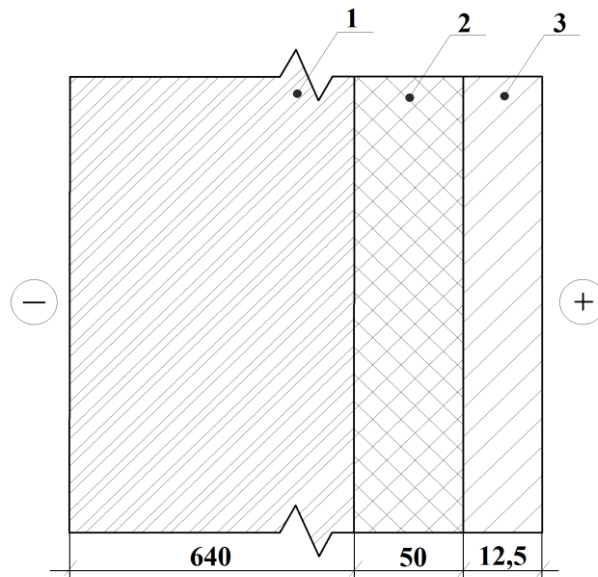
Конструкция кирпичной наружной стены, утепленная с внутренней стороны пеноплексом:
